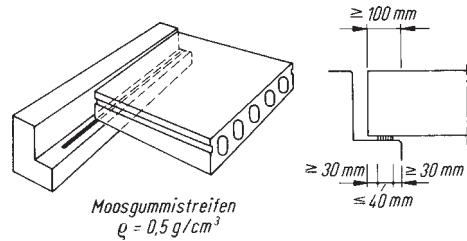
Auflagerung von Spannbetonhohlplatten (nach [221])
